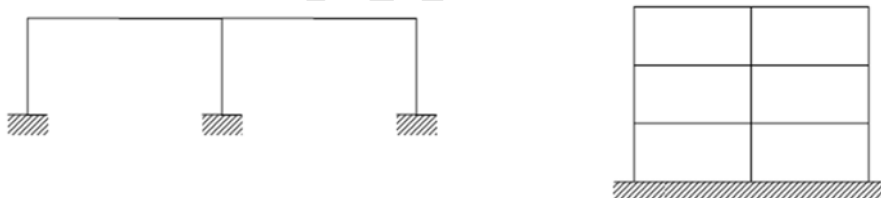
Strutture a telaio con collegamenti monolitici
